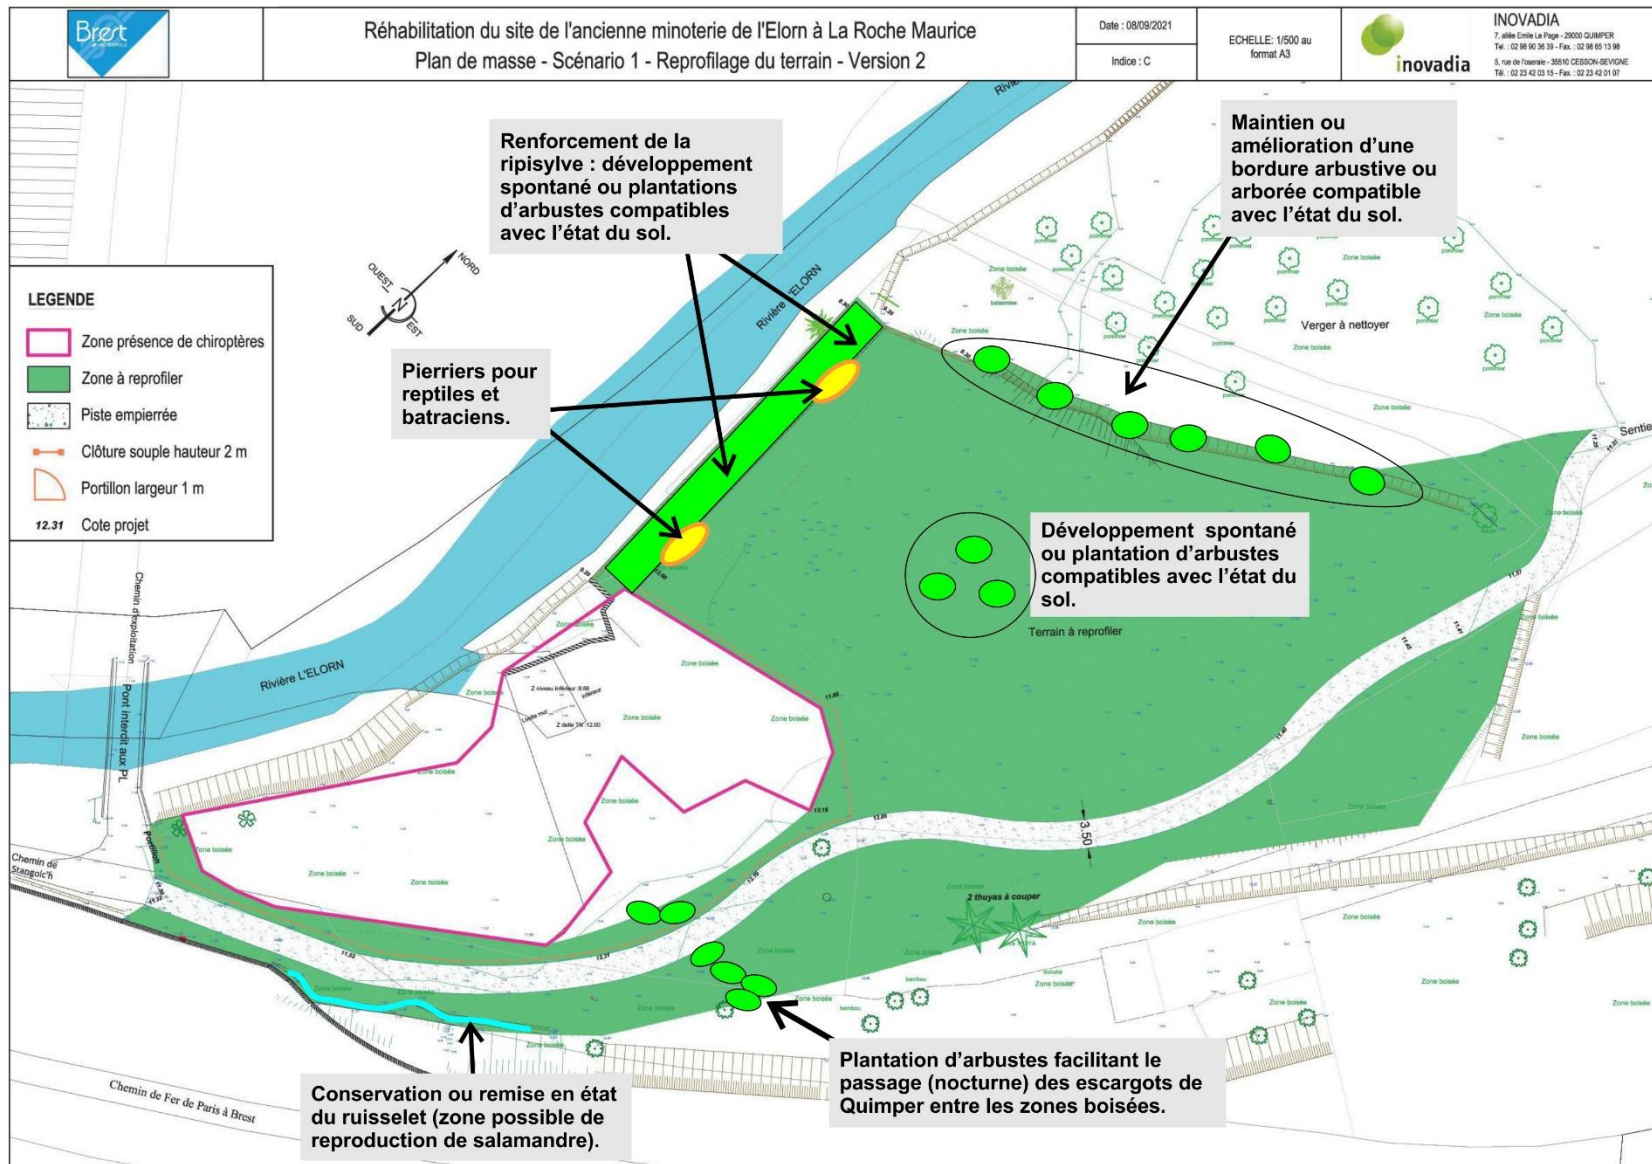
Localisations des aménagements qui seront mis en place après les travaux du site, repousses favorisées ou replantations d'arbustes et installations de pierriers (plan Brst Métropole / syndicat de Bassin de L'Elorn).
